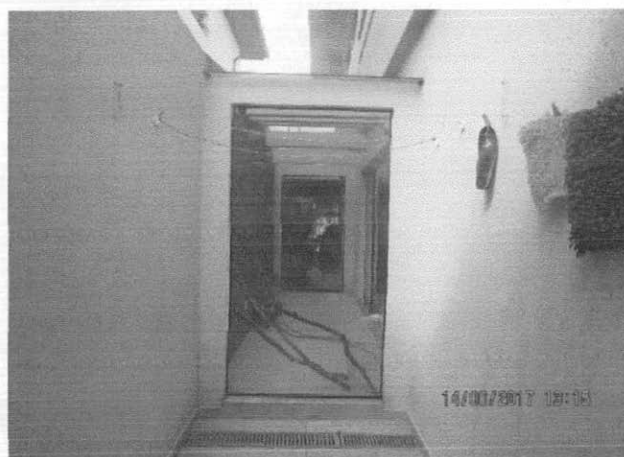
Vista Área Coberta Corredor Lateral
